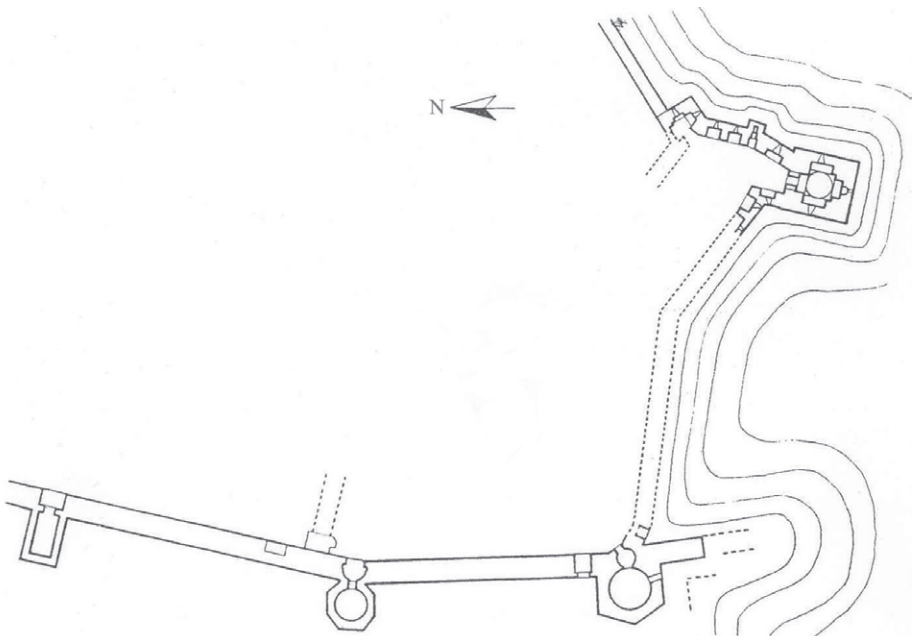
Mermerkule, Lageplan (nach Peschlow)
